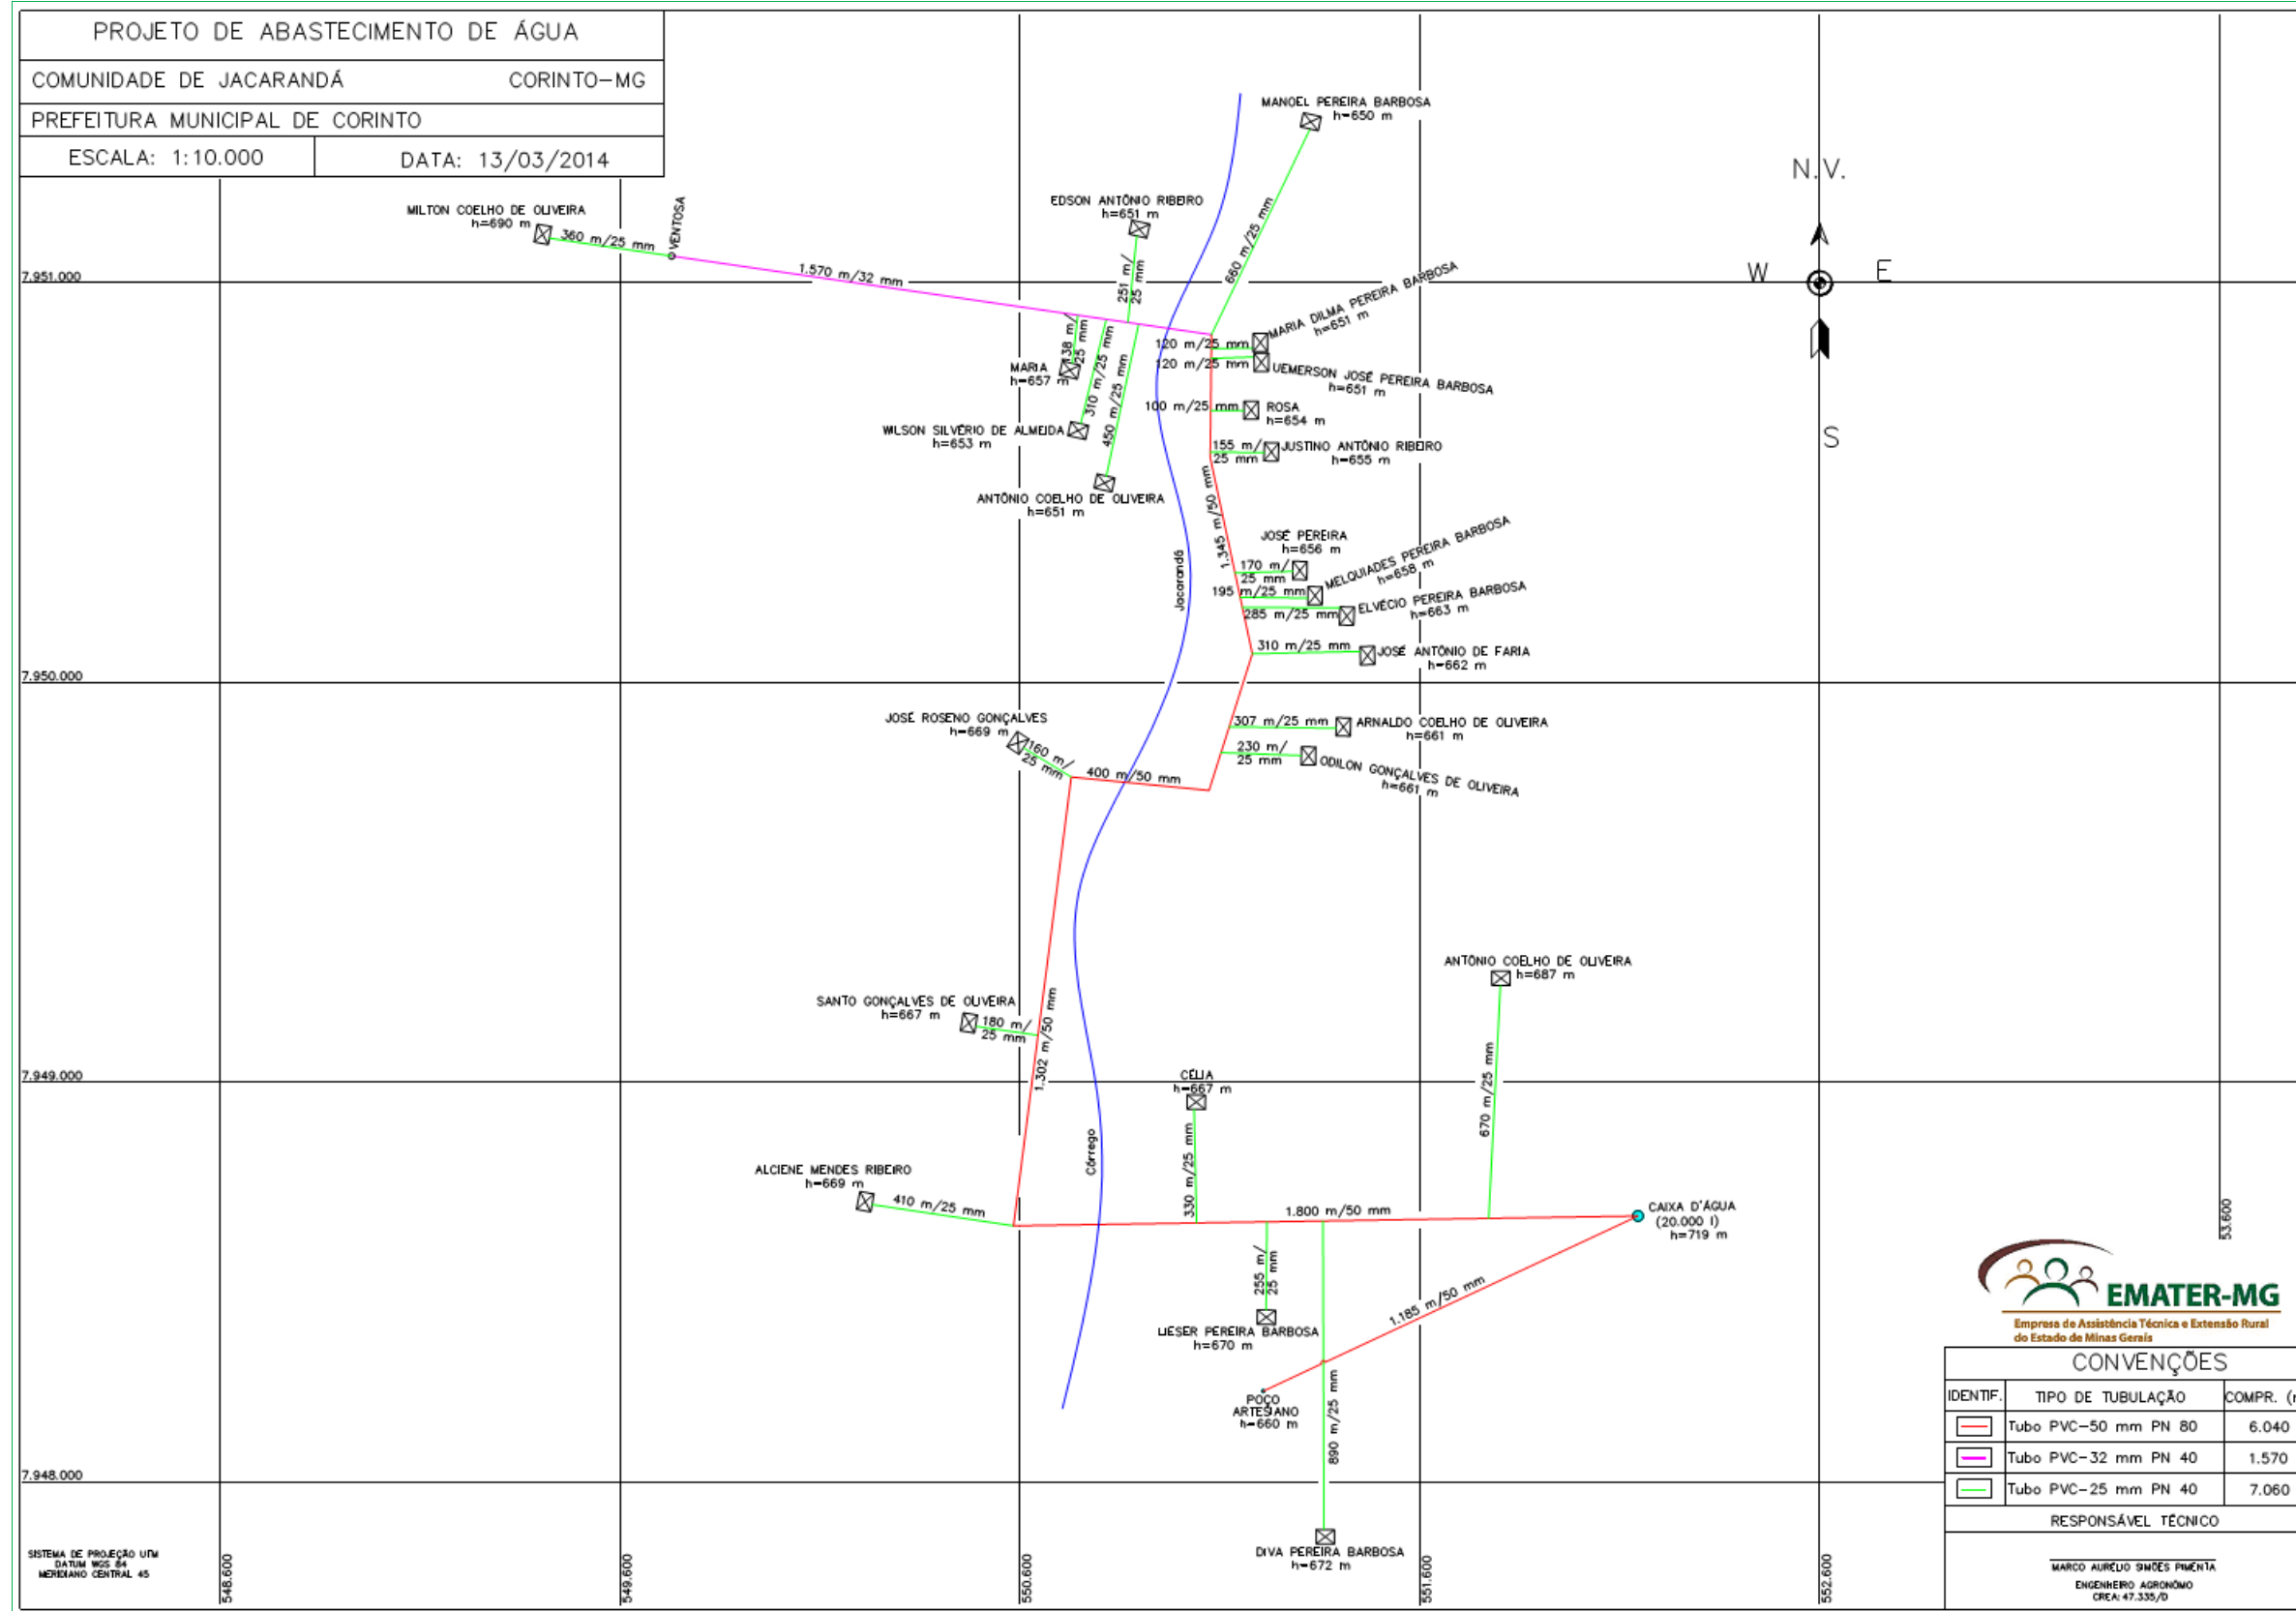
Planta geral do SAA elaborado pela EMATER.
